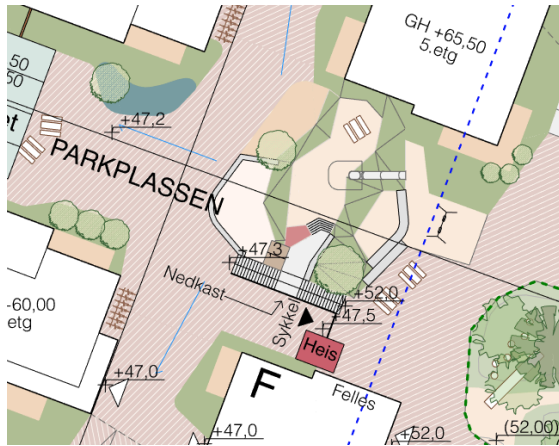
Utsnitt fra illustrasjonsplan. Allmenningen – bindeleddet mellom parken og torget.
